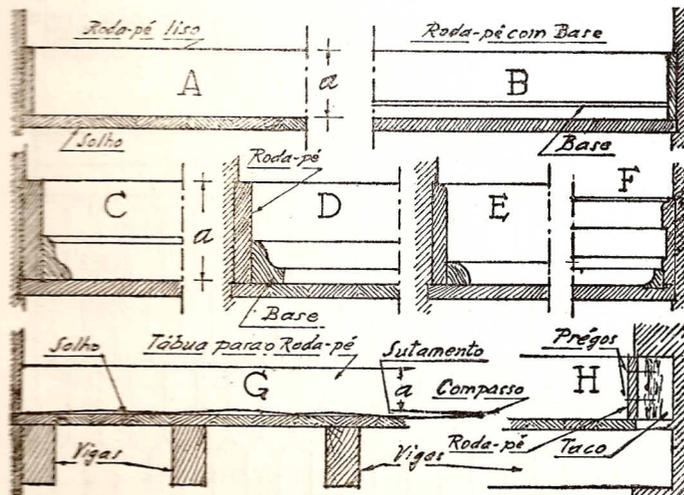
DIVERSOS TIPOS DE RODAPÉ
